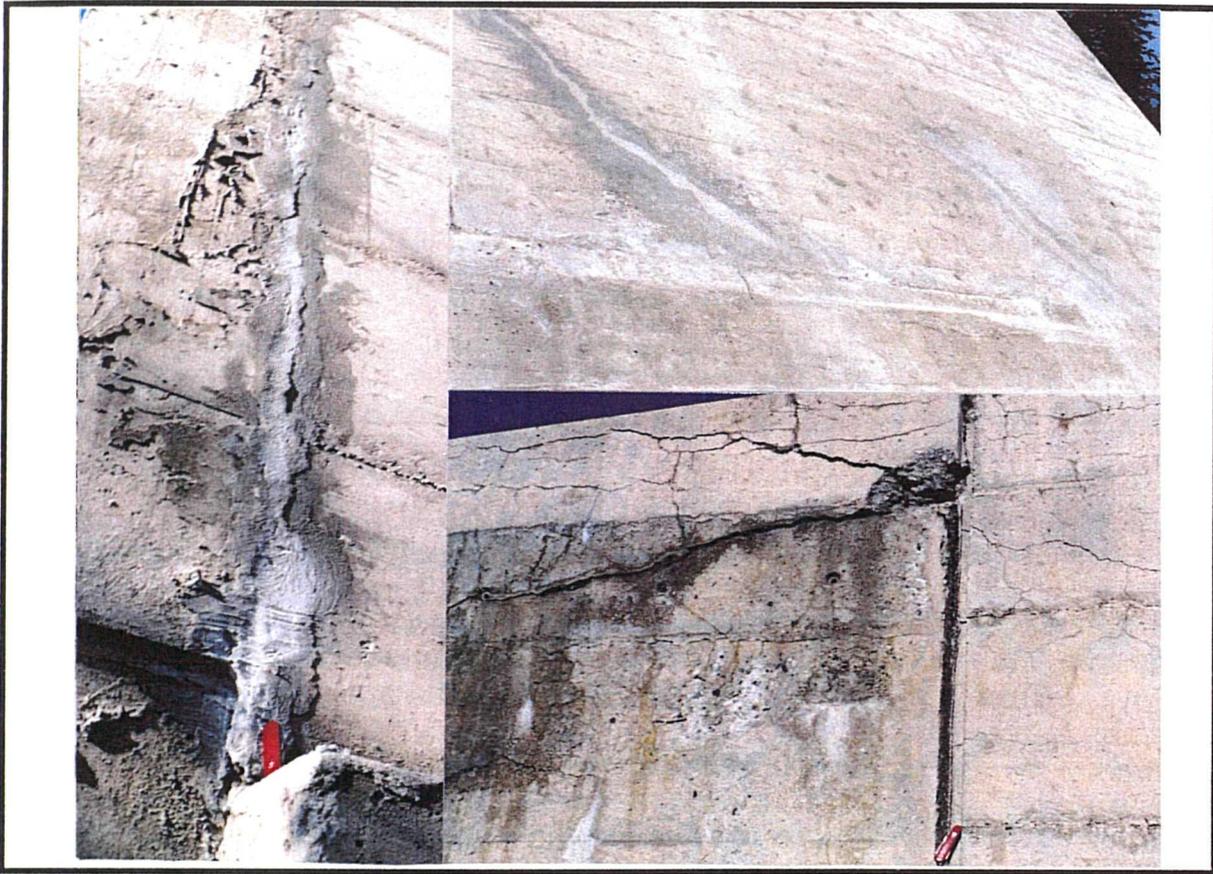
Fissures dans l'énorme parking à l'entrée de Saint-Luc.
